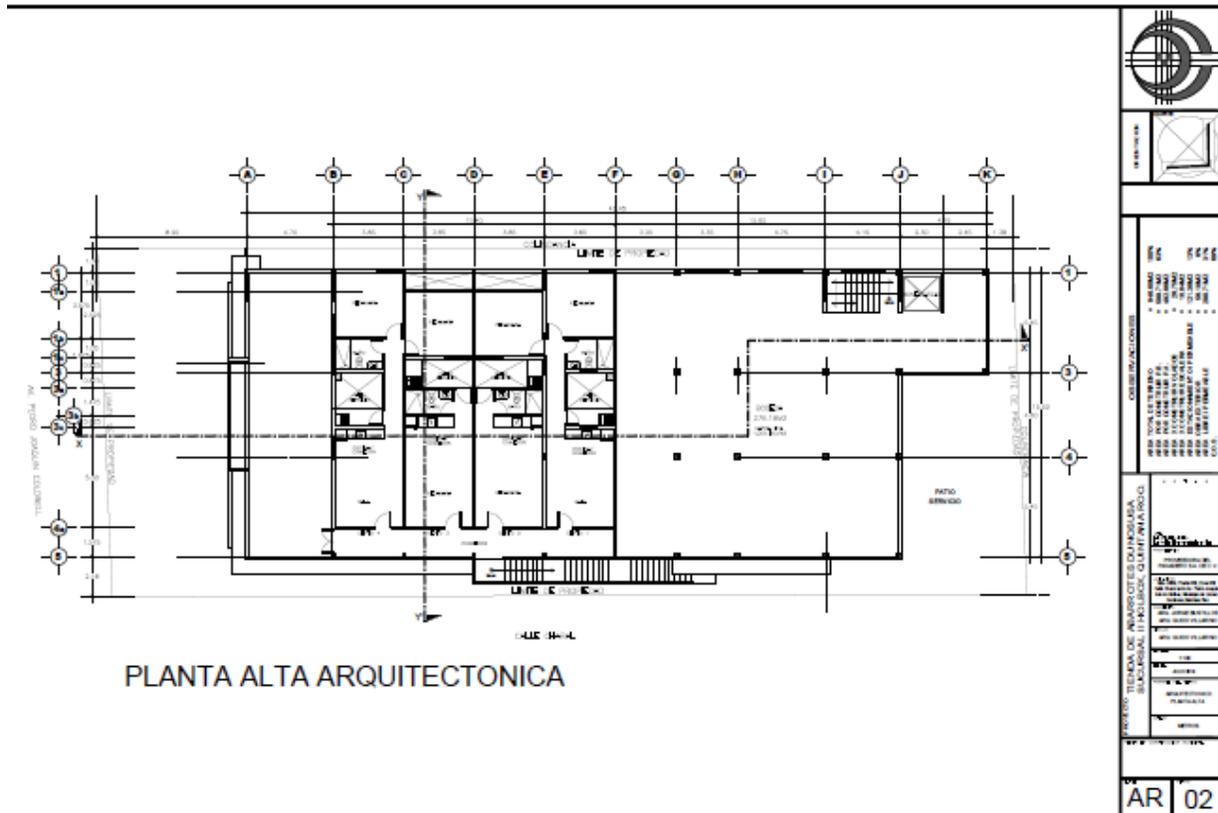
Planta arquitectónica del proyecto (planta alta)
